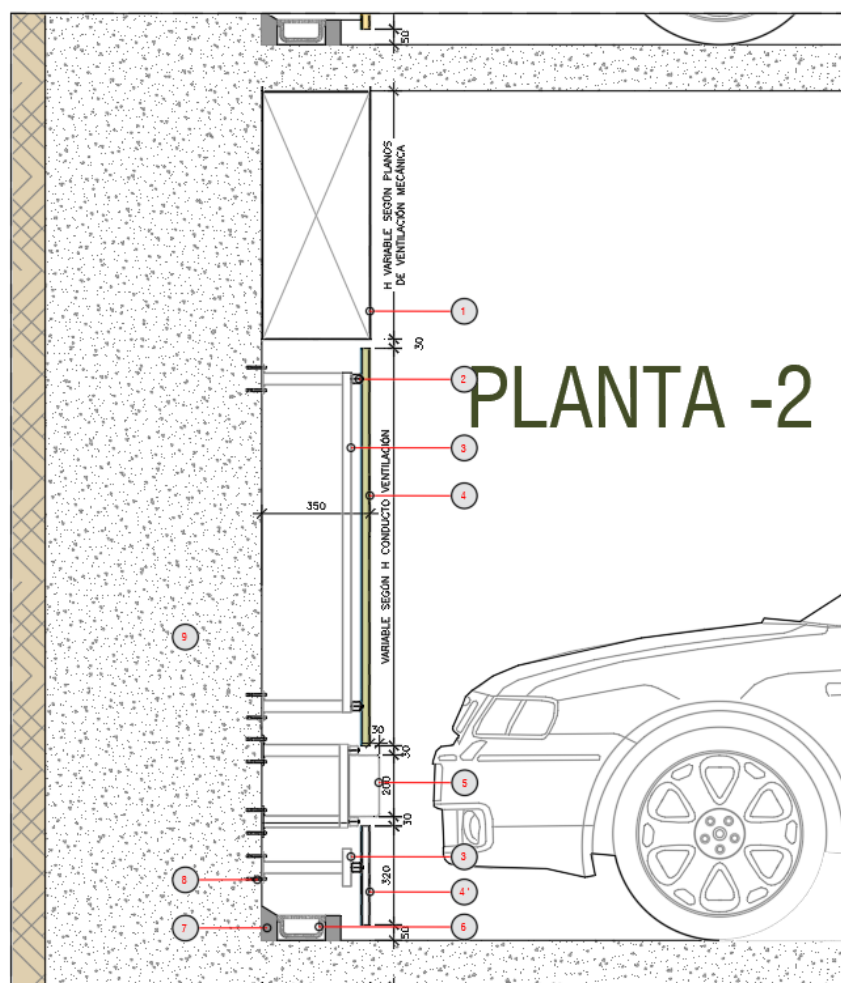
Vista en alzado de la solución proyectada en muros frontales
